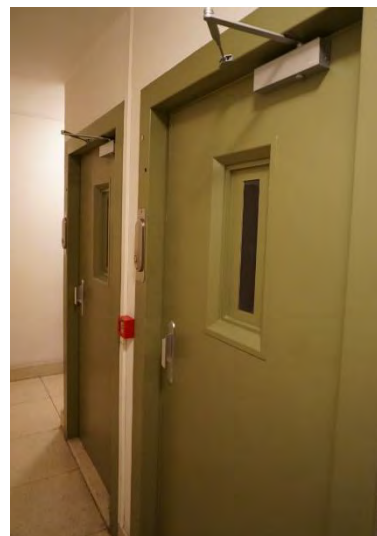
Traphal geeft rechtstreeks uit op hal naar toegangsdeuren appartementen, met uitzondering van trap naar liftmachinekamer
